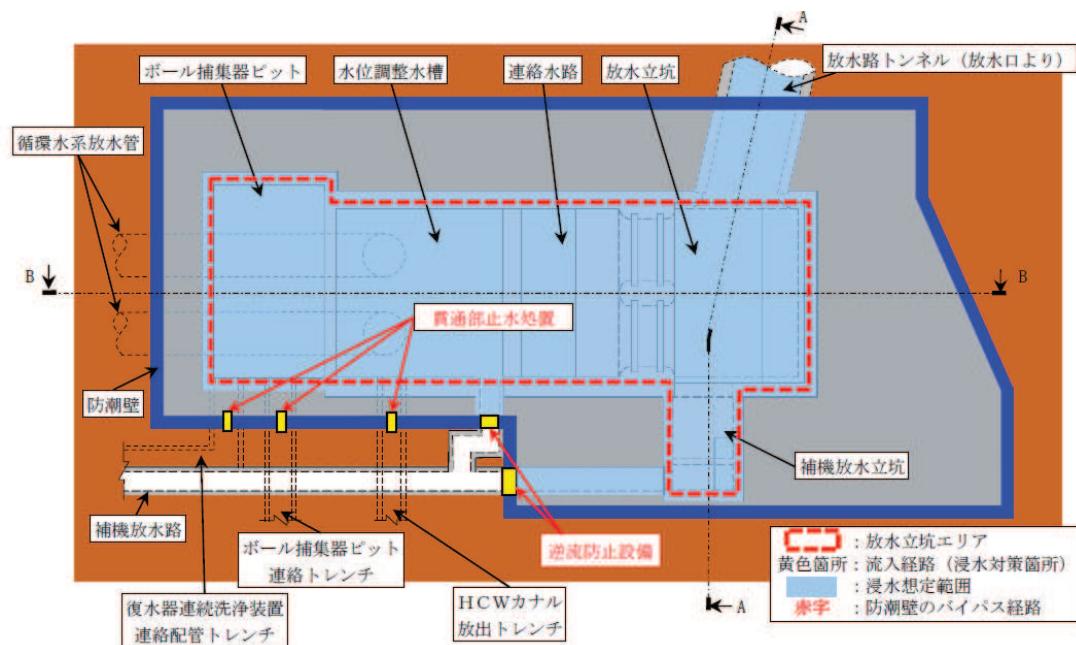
第 2 号機 放水立坑 浸水対策配置図（平面図）
